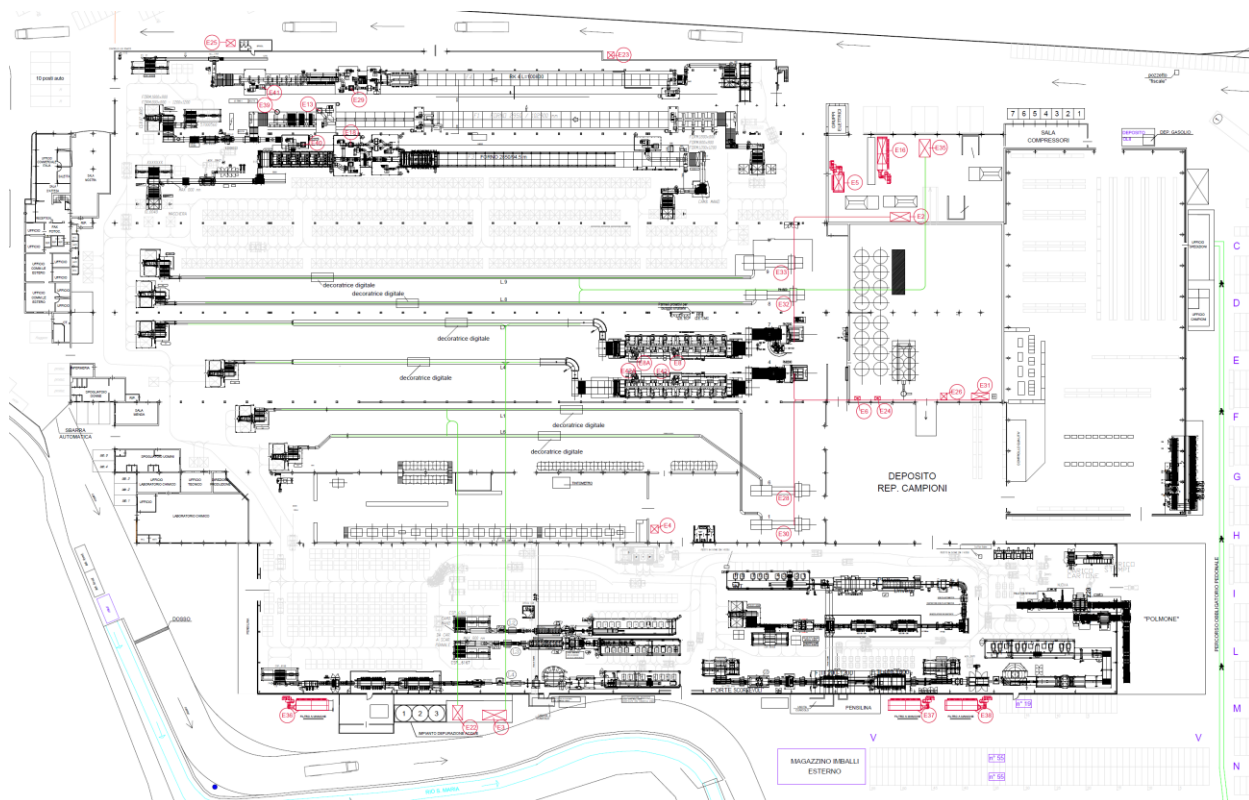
estratto della planimetria dello stato attuale dello stabilimento
